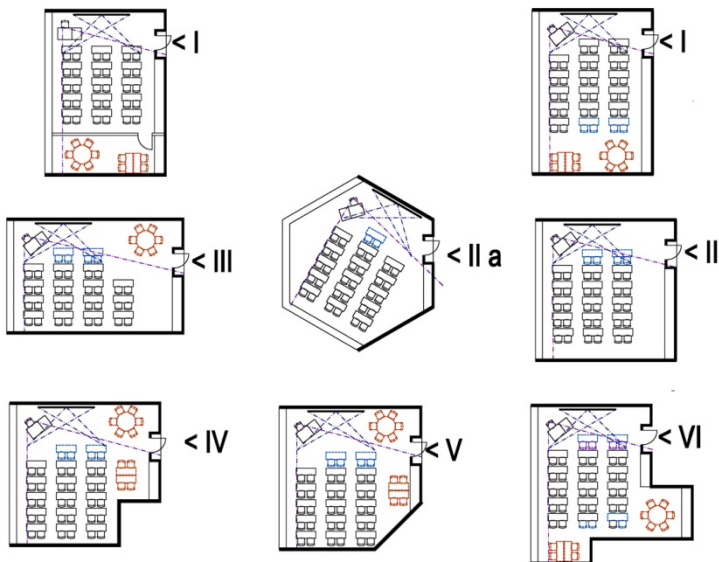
Otevřené vyučování⁽⁵⁵⁾
